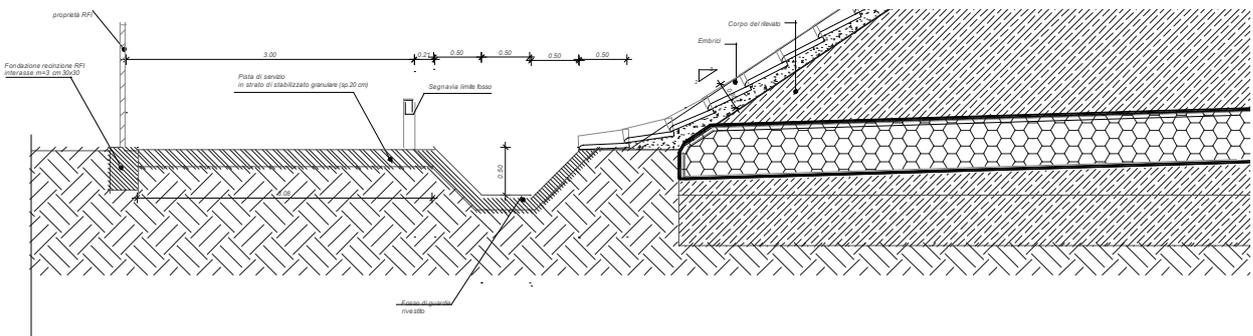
Dettaglio alla base del rilevato ferroviario
